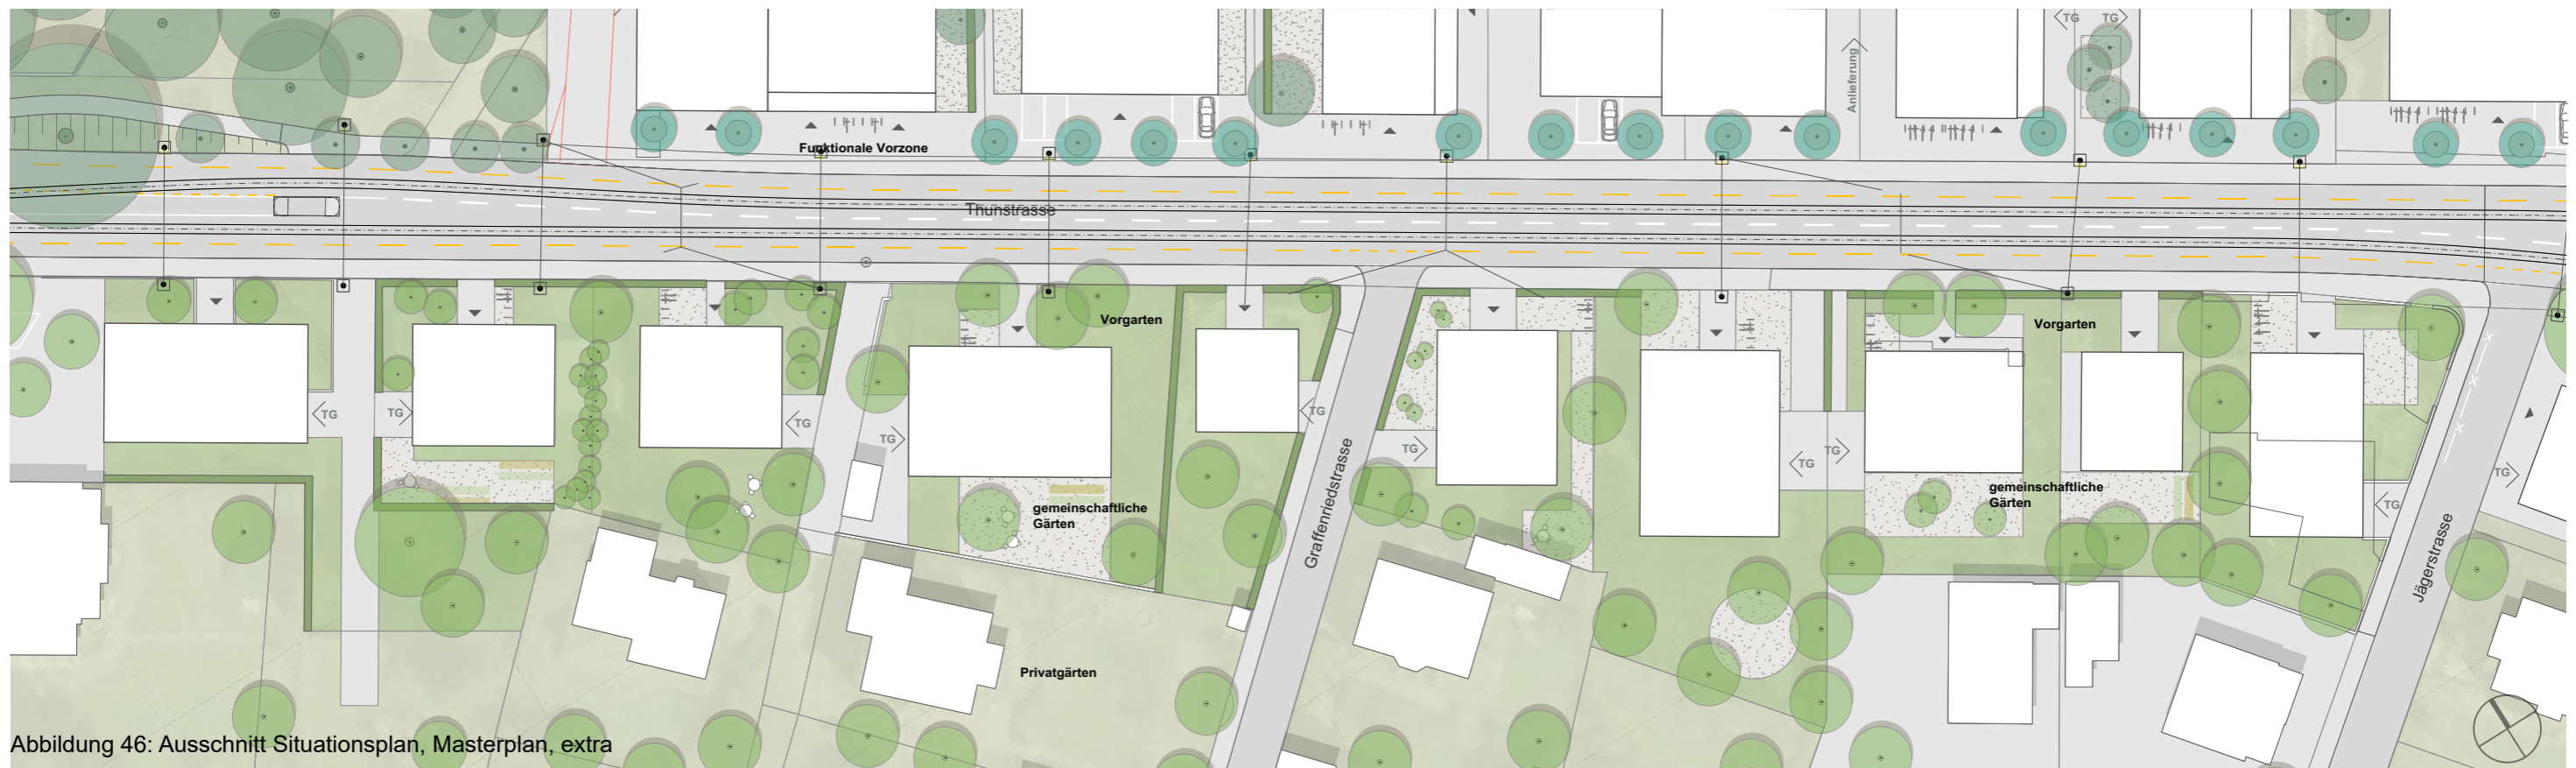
Ausschnitt Situationsplan, Masterplan, extra
